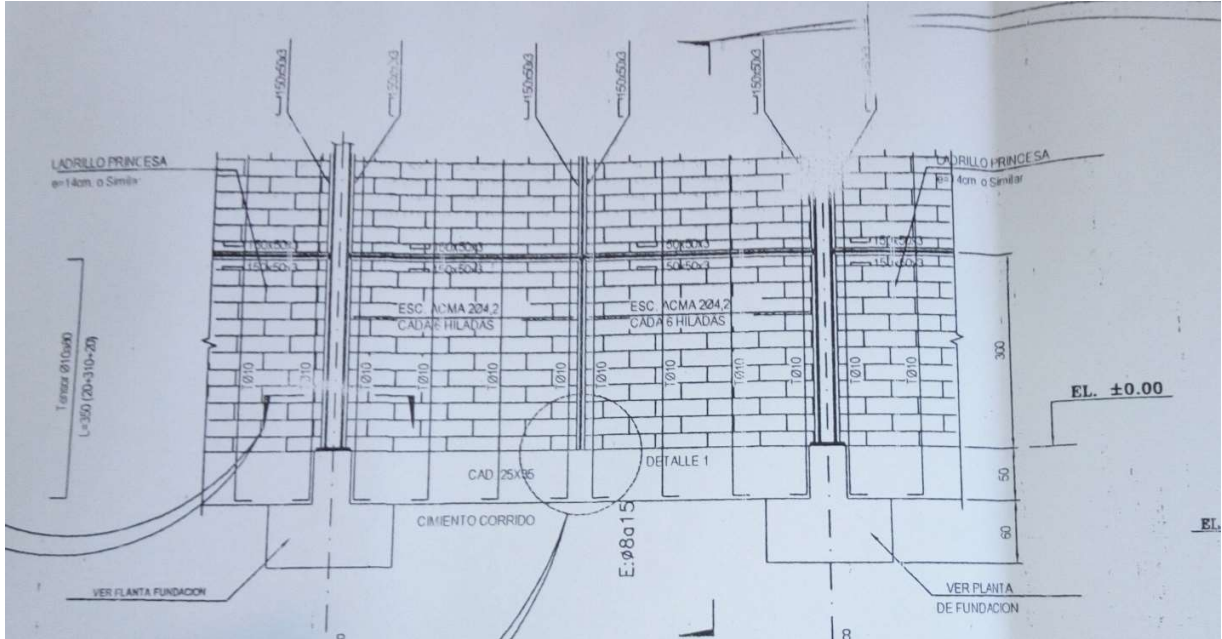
Refuerzo vertical y horizontal en muros de estructura en San Bernardo.
